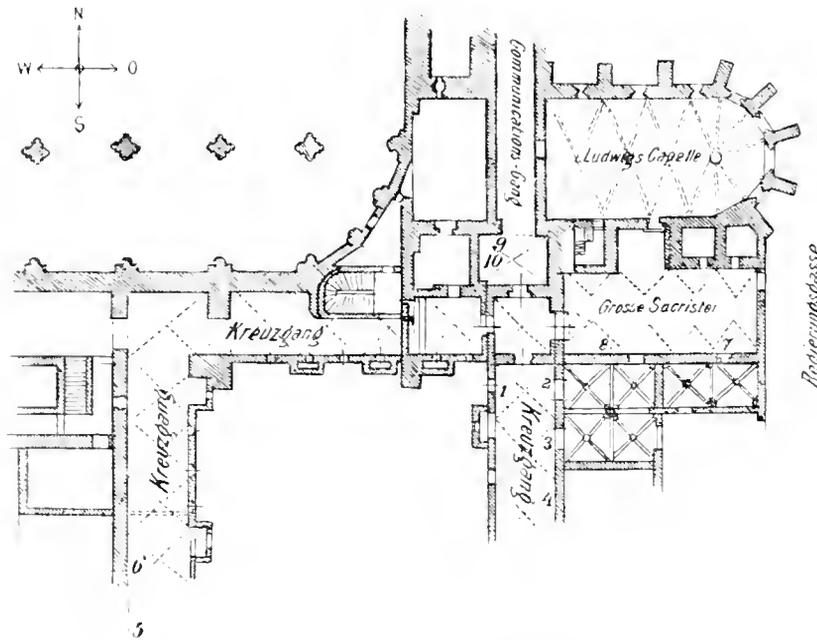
Grundriss des ehemaligen Kreuzganges bei der Minoritenkirche zu Wien, sammt den umliegenden Klosterbaulichkeiten.
